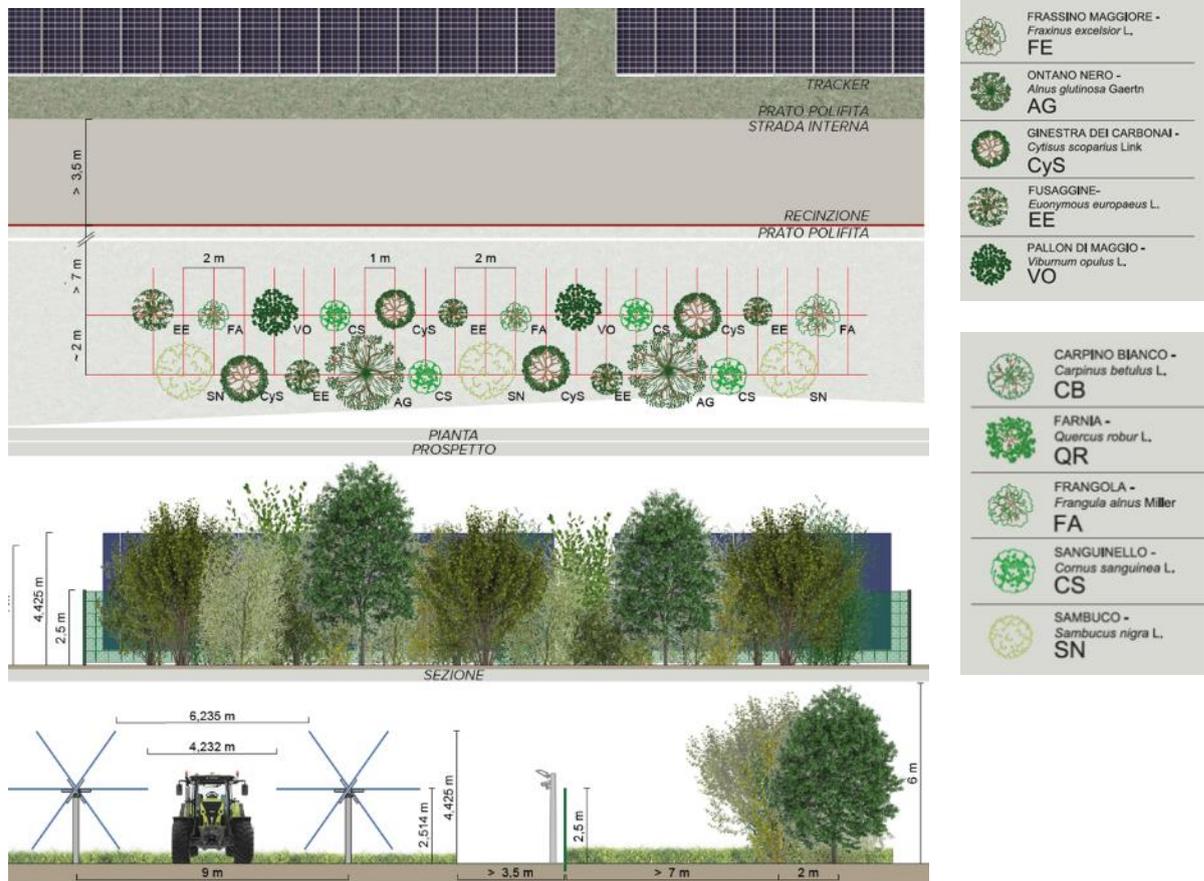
Il sesto d'impianto delle fasce di mitigazione a doppio filare di Tipo 1
